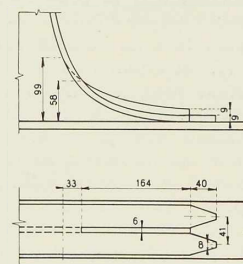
Détails de construction du nœud type n° 7 (fig. 313).
